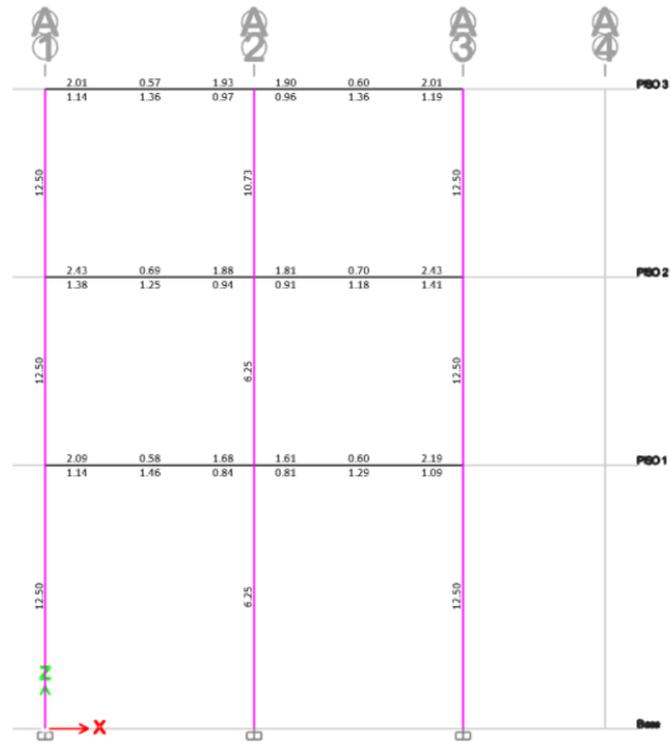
Área de acero en columnas, Pórtico B-B
